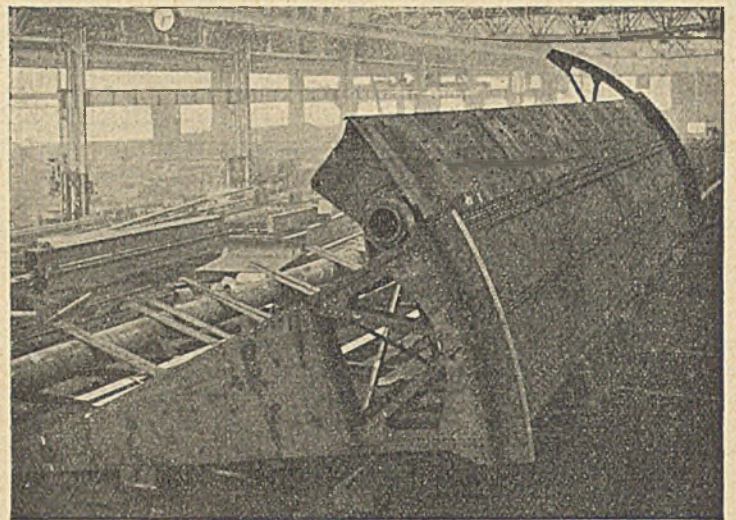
Segmentwehr mit Eisklappe für Boberröhrsdorf in Schlesien.
